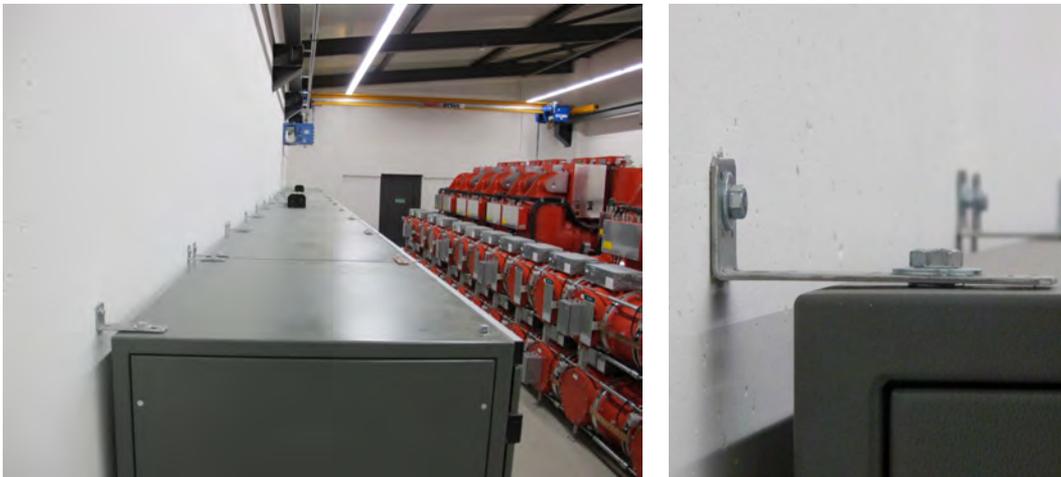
/E.5 Armadi di comando fissati alla parete attraverso barre di metallo ad angolo (Axp)
